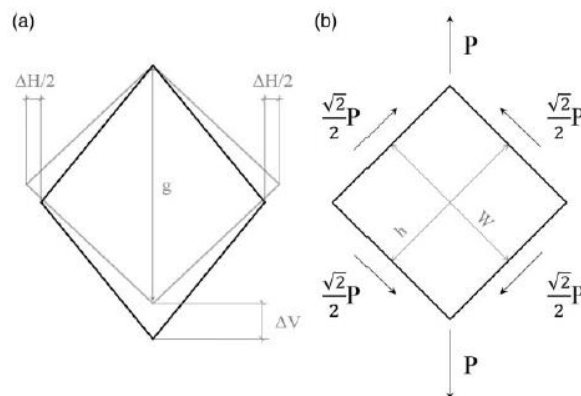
Configuração do ensaio DTS: (a) geometria deformada (b) equilíbrio de forças [137]
